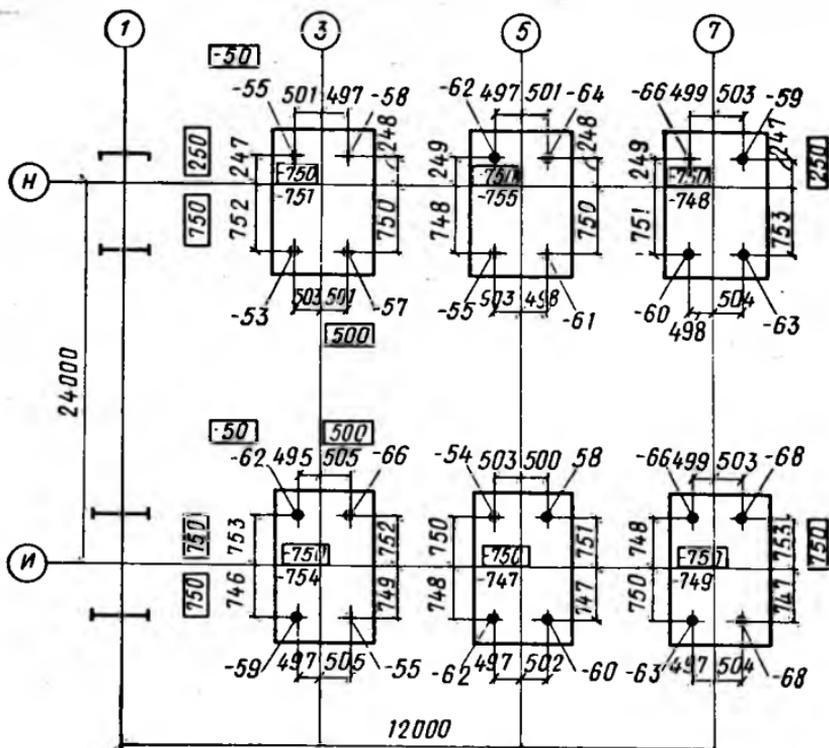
Исполнительная схема положения фундаментных болтов и опорной поверхности фундамента (для стальных колонн цифры у стрелок показывают положение фундаментных болтов относительно разбивочных осей; цифры у выносных линий — отметки верха болтов и поверхности фундамента; в рамках указаны проектные значения)
